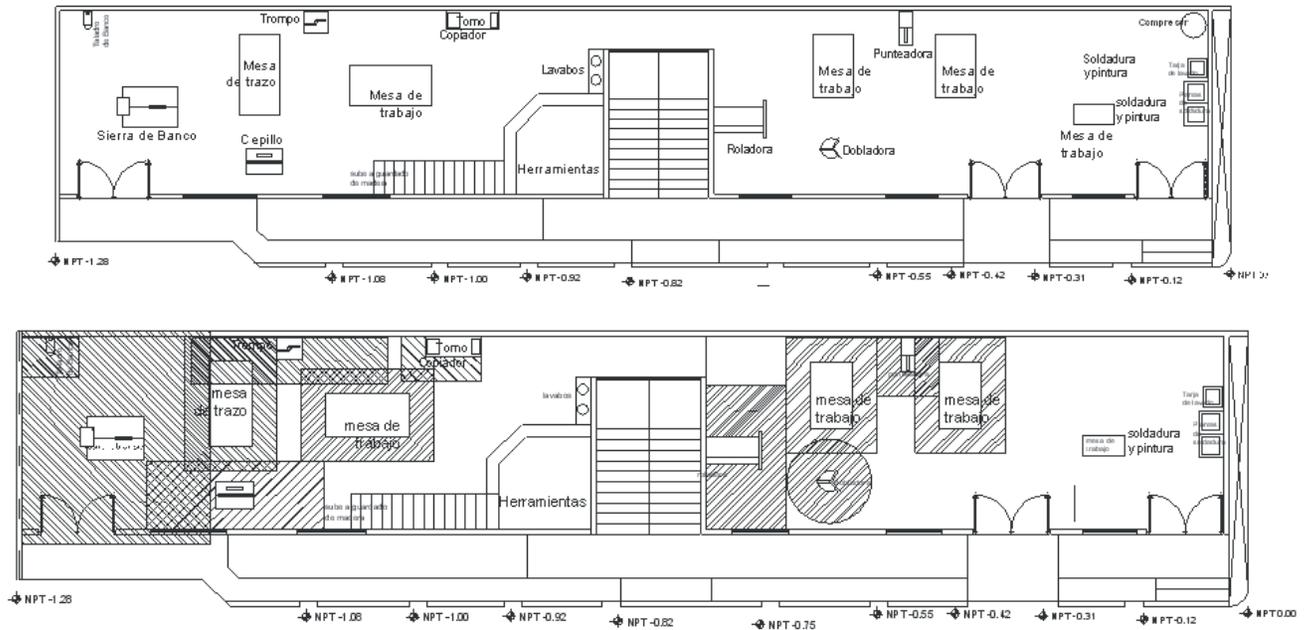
Distribución definitiva de la planta baja, taller de carpintería-herrería (en la parte superior se muestran las máquinas sin área de trabajo, en la inferior con áreas de trabajo).
